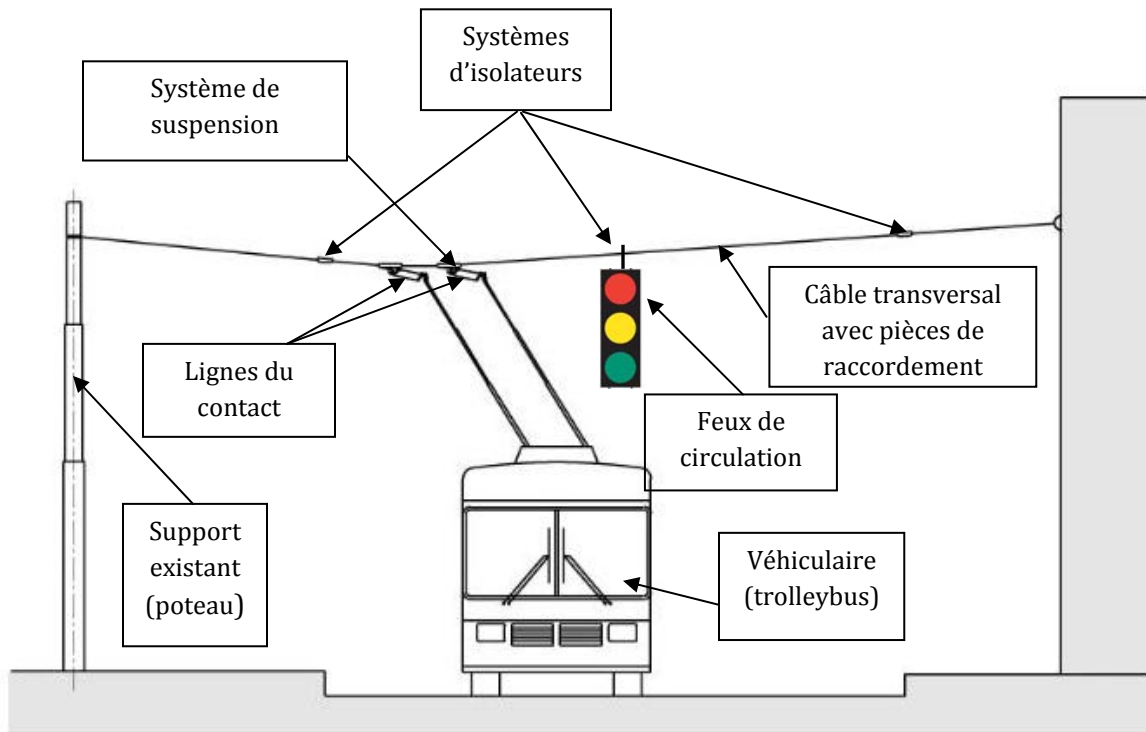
INSTALLATION TYPIQUE AVEC CÂBLE TRANSVERSAL
